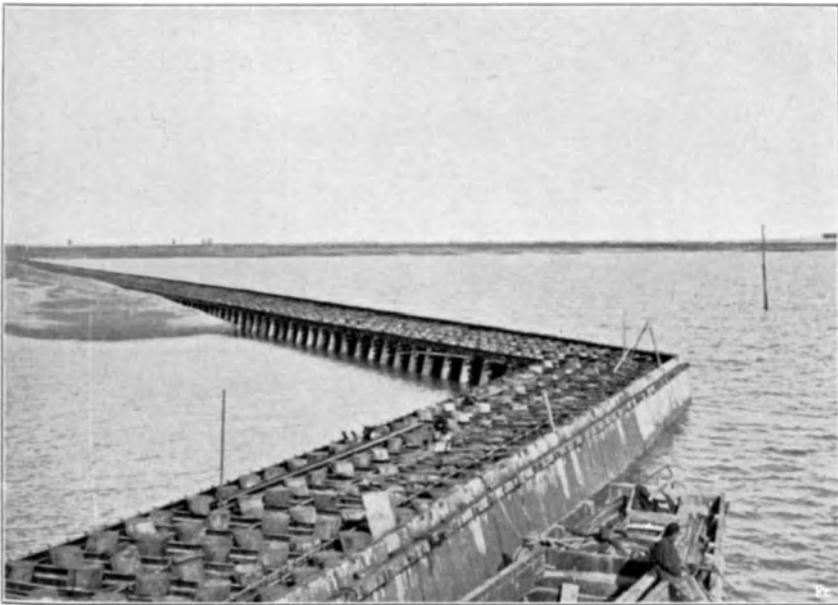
a. Kaimauer in Tsingtau; hölzerner Pfahlrost mit Betonspundwand.
